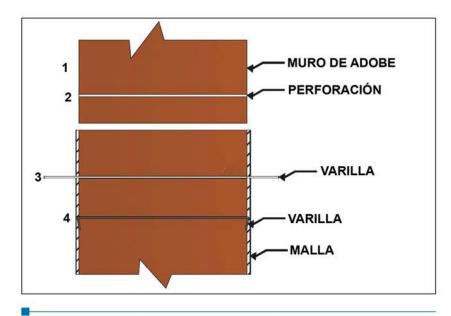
Detalle del reforzamiento en corte vertical de la pared, mostrando cómo las mallas (externa e interna) son vinculadas con la varilla corrugada. Modificado de: P. Bonilla (2002).
